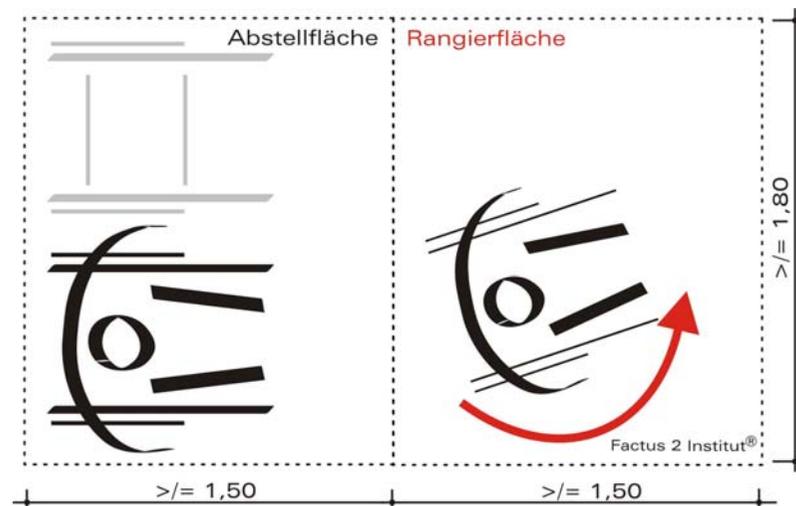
© Factus 2 Institut® Rollstuhlabbstellplatz inkl. Rangierfläche
